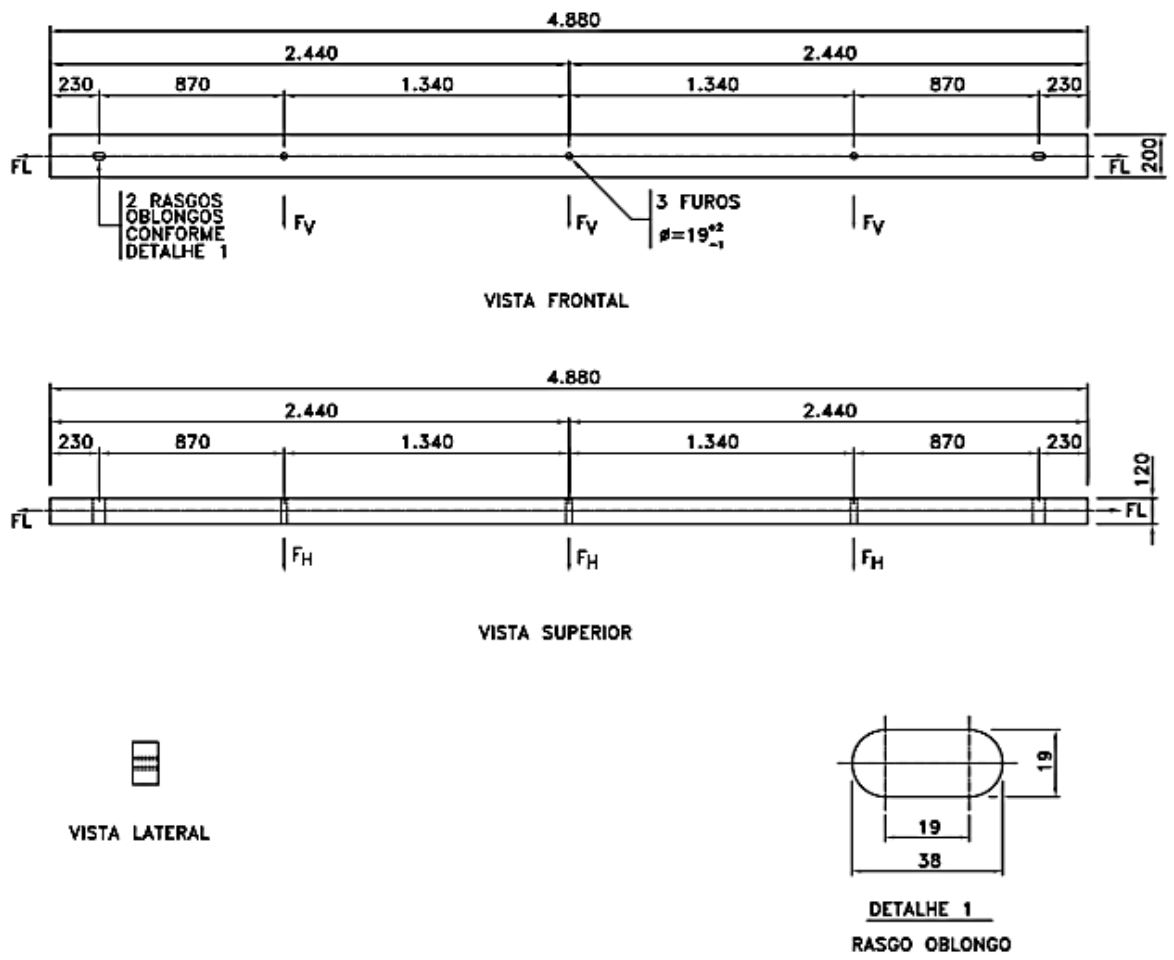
Viga de concreto armado de 120x200x4.880mm, montagem vertical
